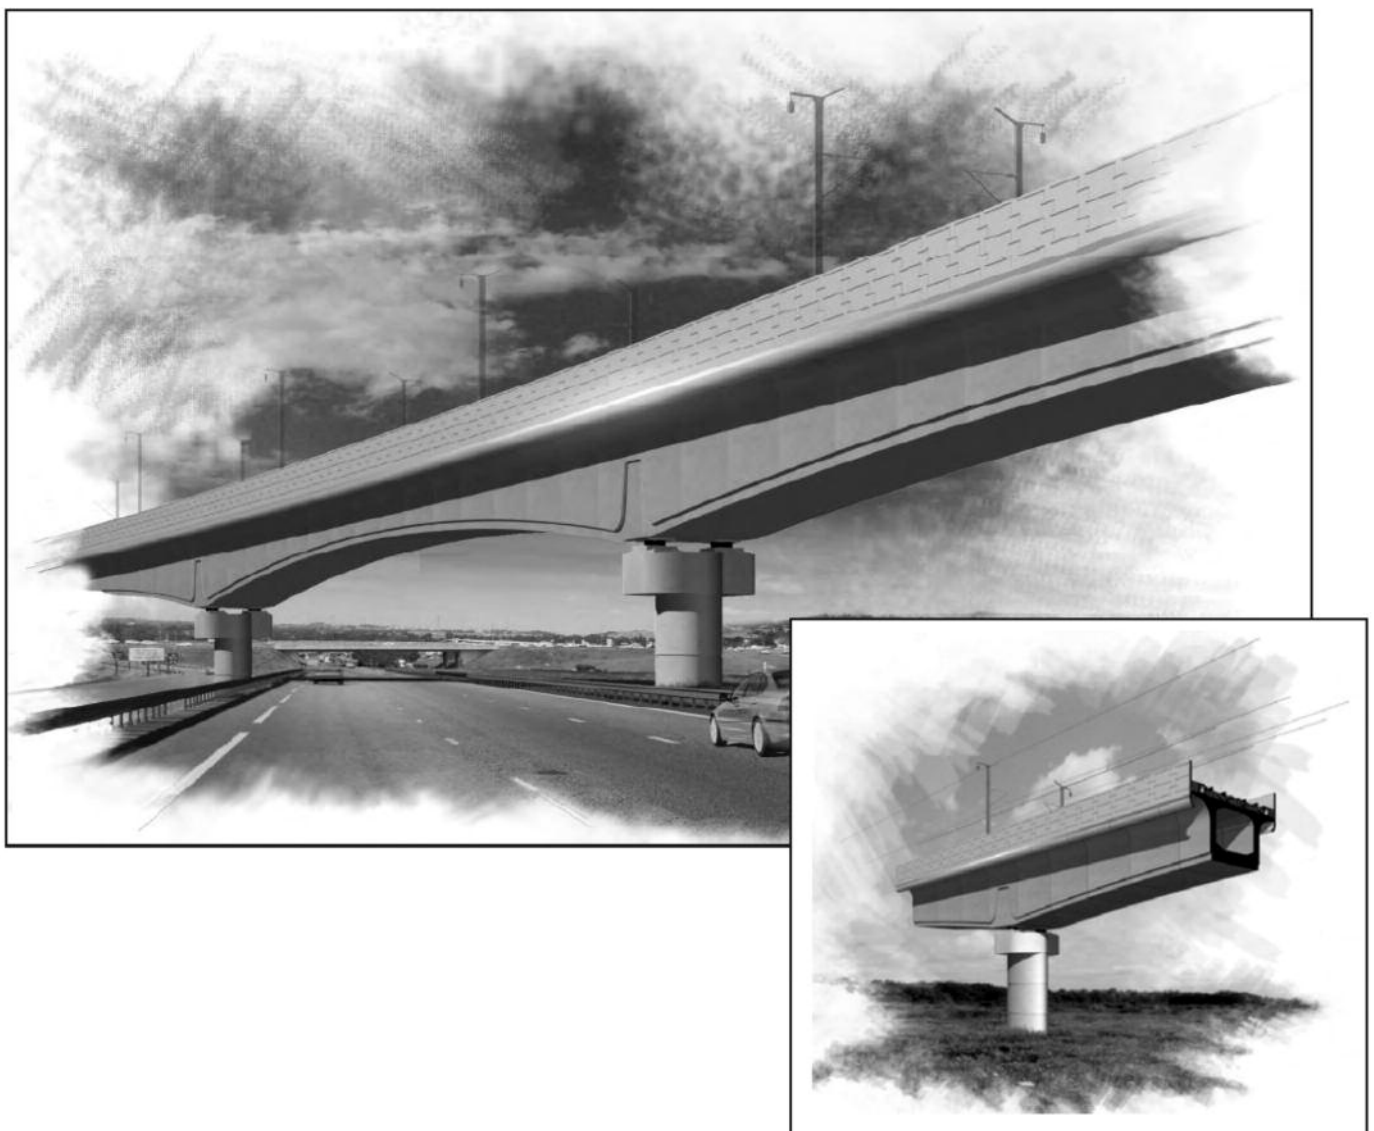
Vue architecturale de Jean Avenue / Architectural view of Jean Avenue viaduct.
